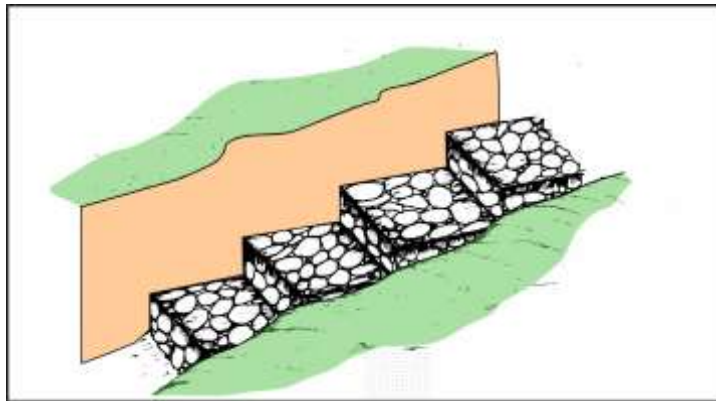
Protección del lecho de la quebrada con muros escalonados (andenes), utilizando bloques de roca o concreto
